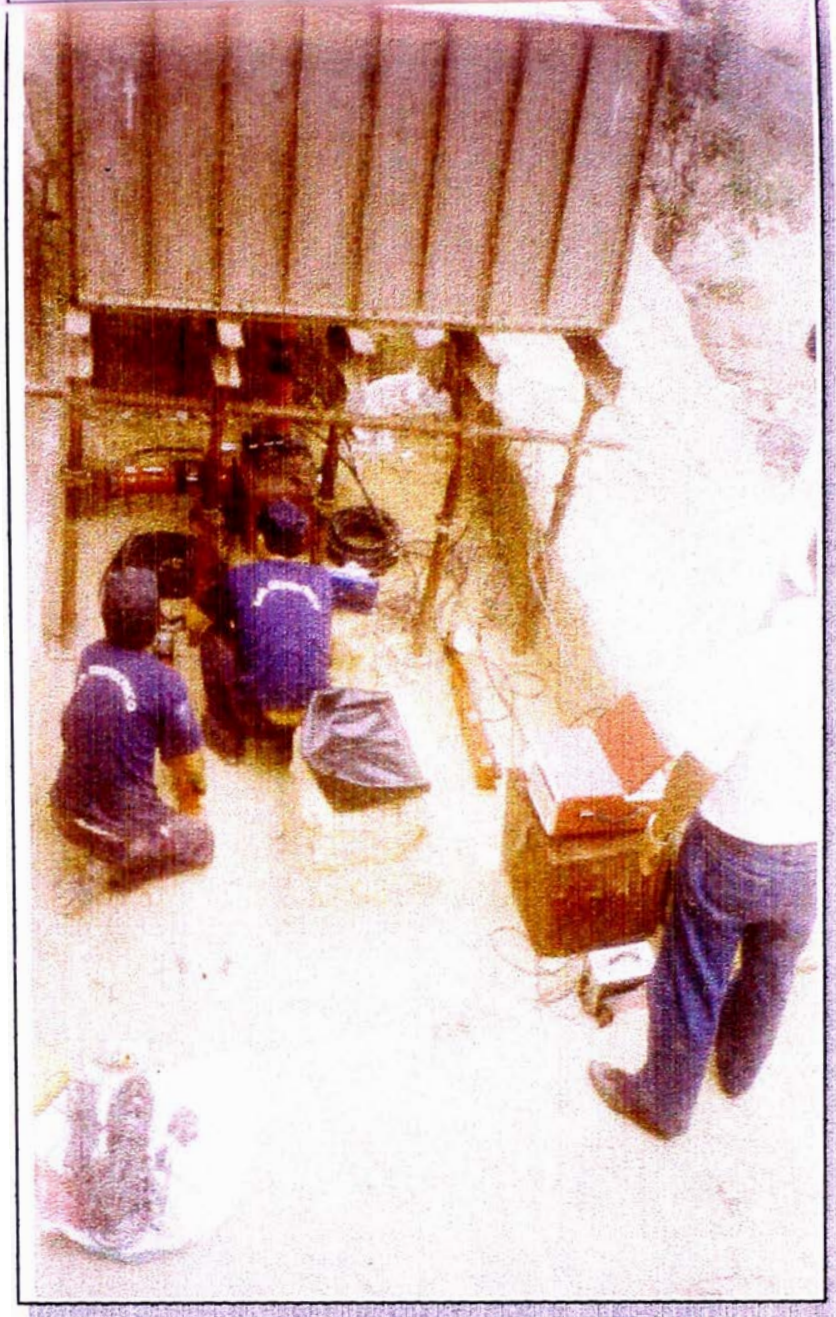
Vista mostrando la realización del Ensayo de corte Directo In-situ
